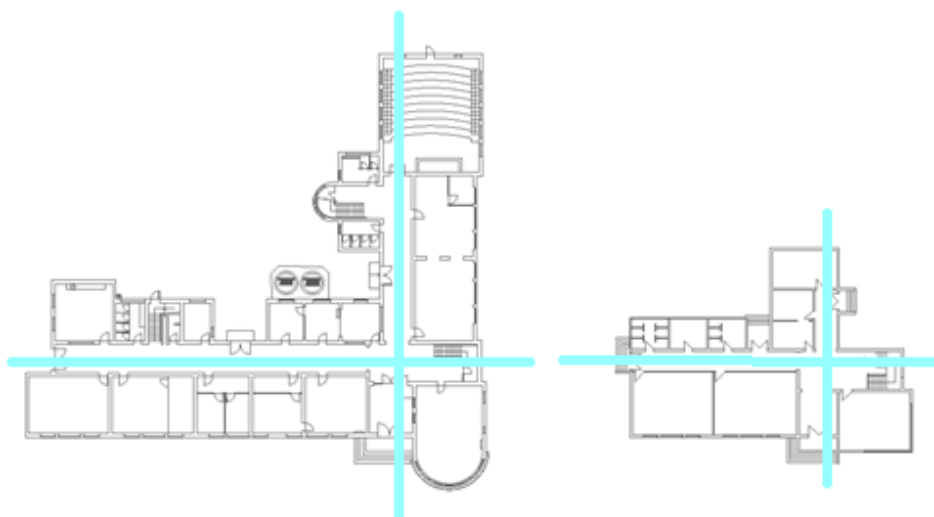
Planta baixa do 1º pavimento das escolas Assis Brasil e Marques de Souza, delimitação de eixo e equilíbrio em relação as circulações.
